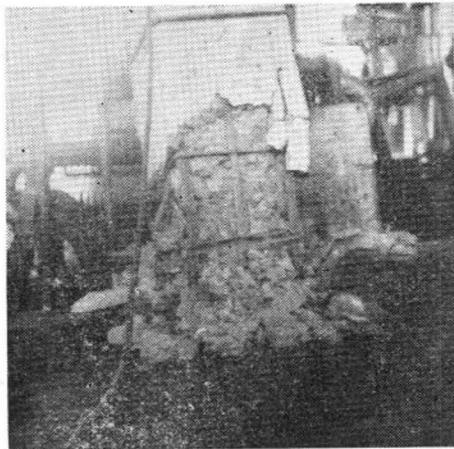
唐山齿轮厂齿轮车间钢筋混凝土柱根部破坏情况
